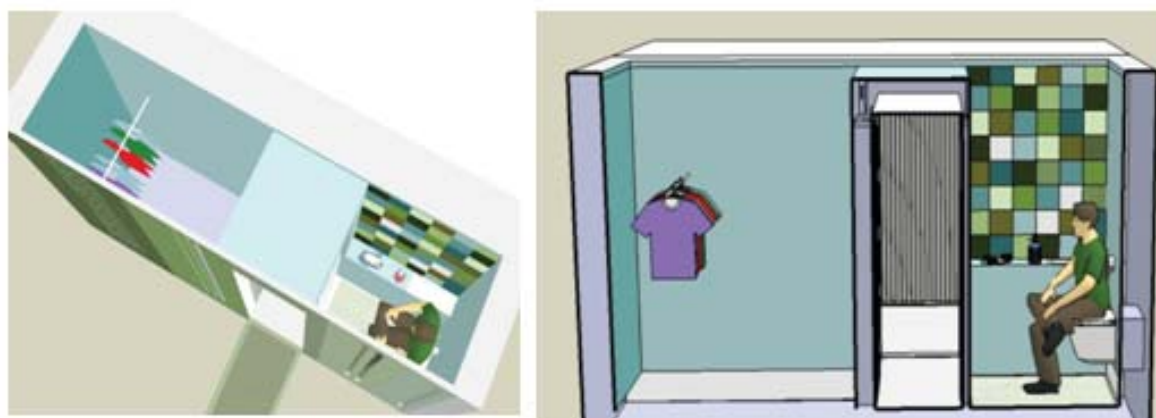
Habitando dentro del muro. Espacio multifuncional privado. De izquierda a derecha: Área de closet-vestir y área de baño-lavadero. Fuente: Elaborado por el autor con Google SketchUp.
